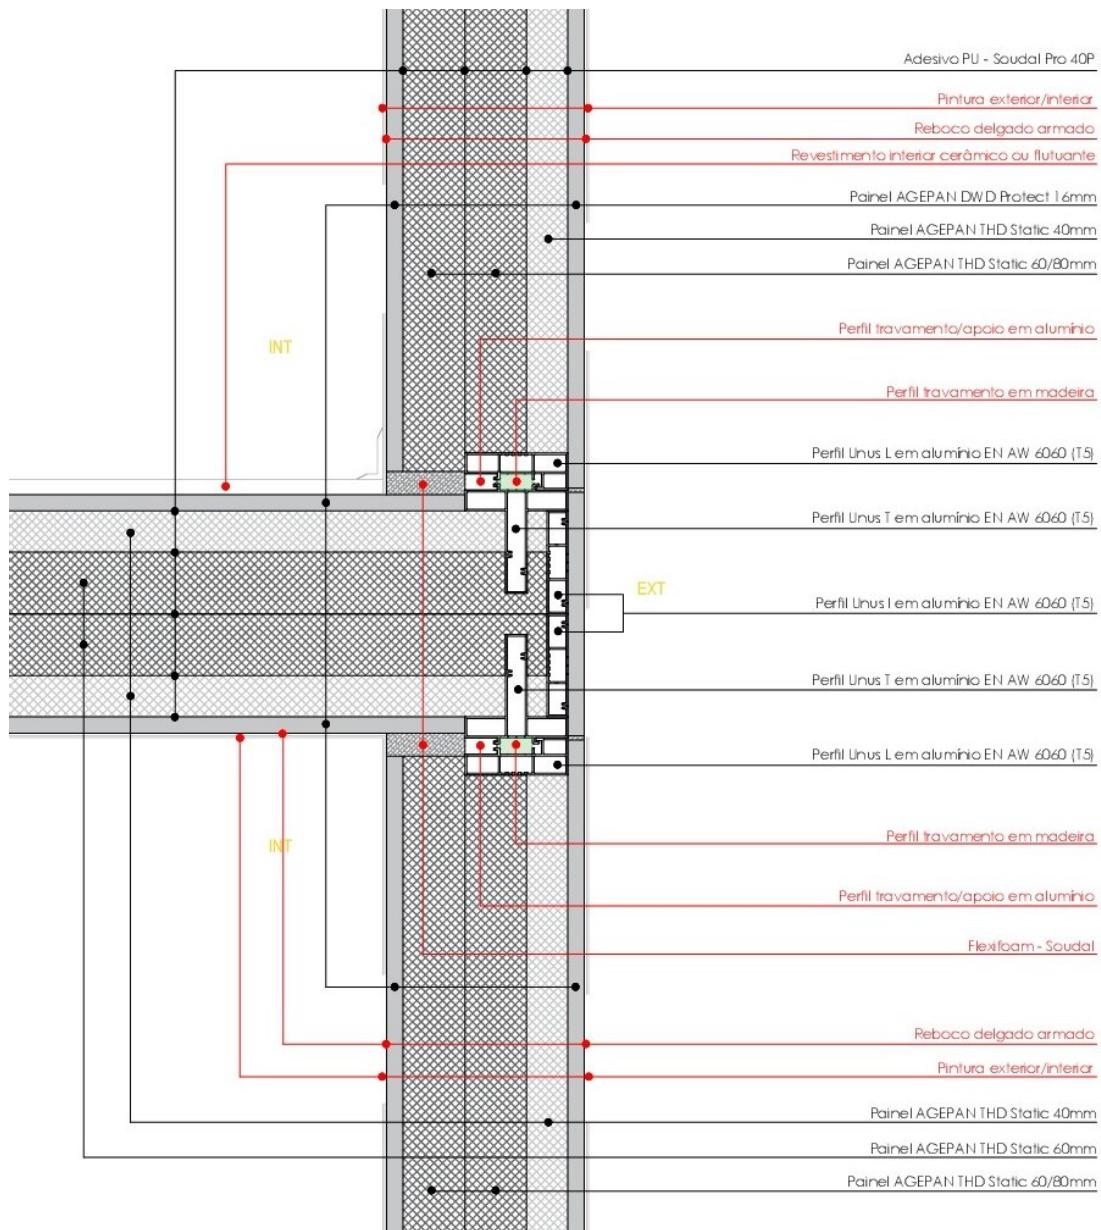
Solução AGEPAN – Pormenor Construtivo de Pisos Intermédios/ Paredes.
